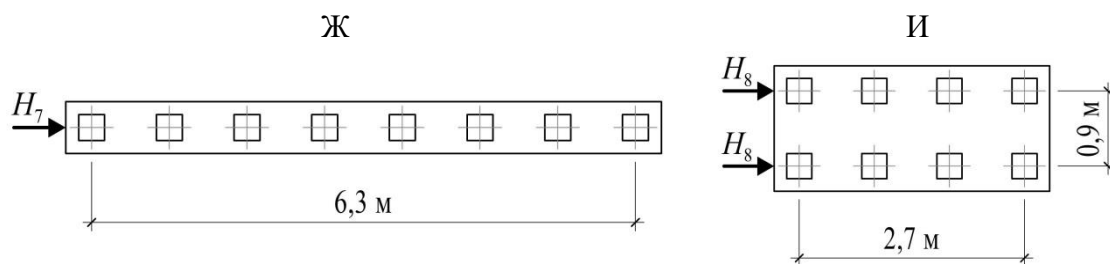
Схемы горизонтально нагруженных фундаментов: Ж – ряд из 8 свай; 3 – группа из 8 свай
